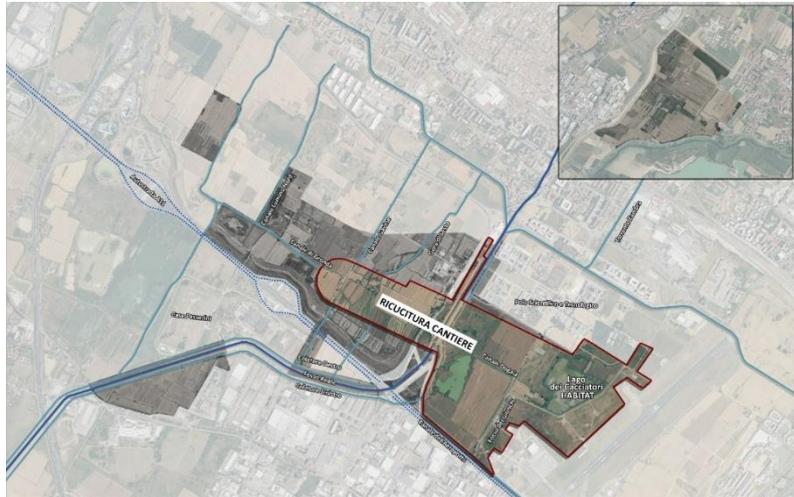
Planimetria di cantierizzazione: ricucitura macrolotti
